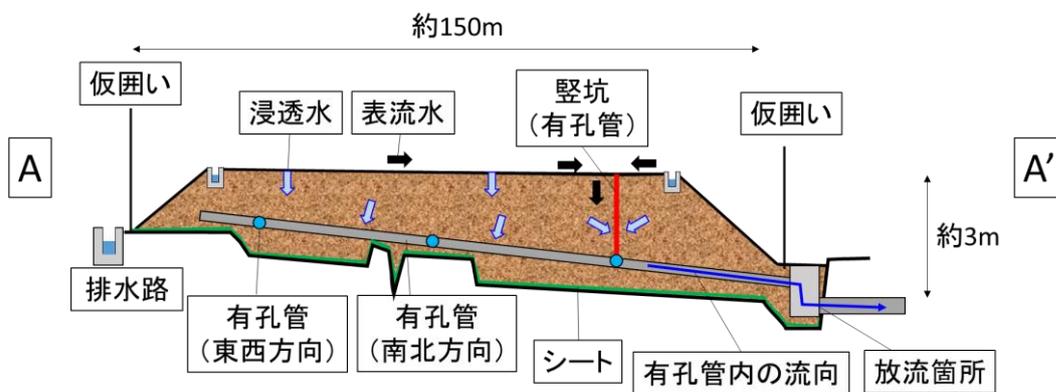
(2) 盛土内有孔管配置図 (A-A' 断面)
